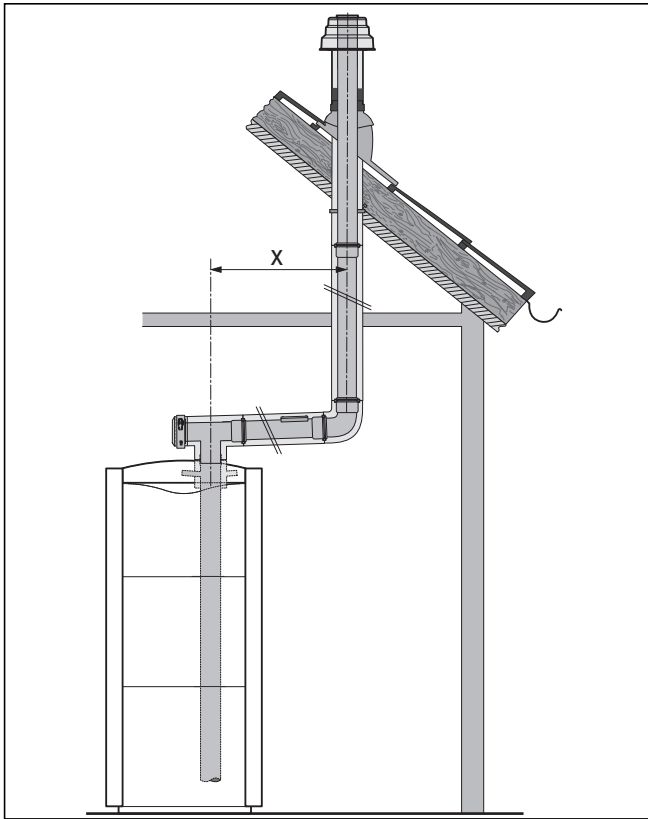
Montagebeispiel senkrechte Dachdurchführung mit Revisions-T-Stück
